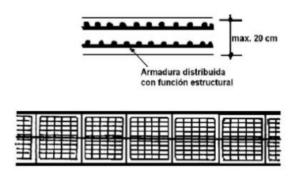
Pavimento de concreto armado con juntas Nota: Alicaresp (2019).
